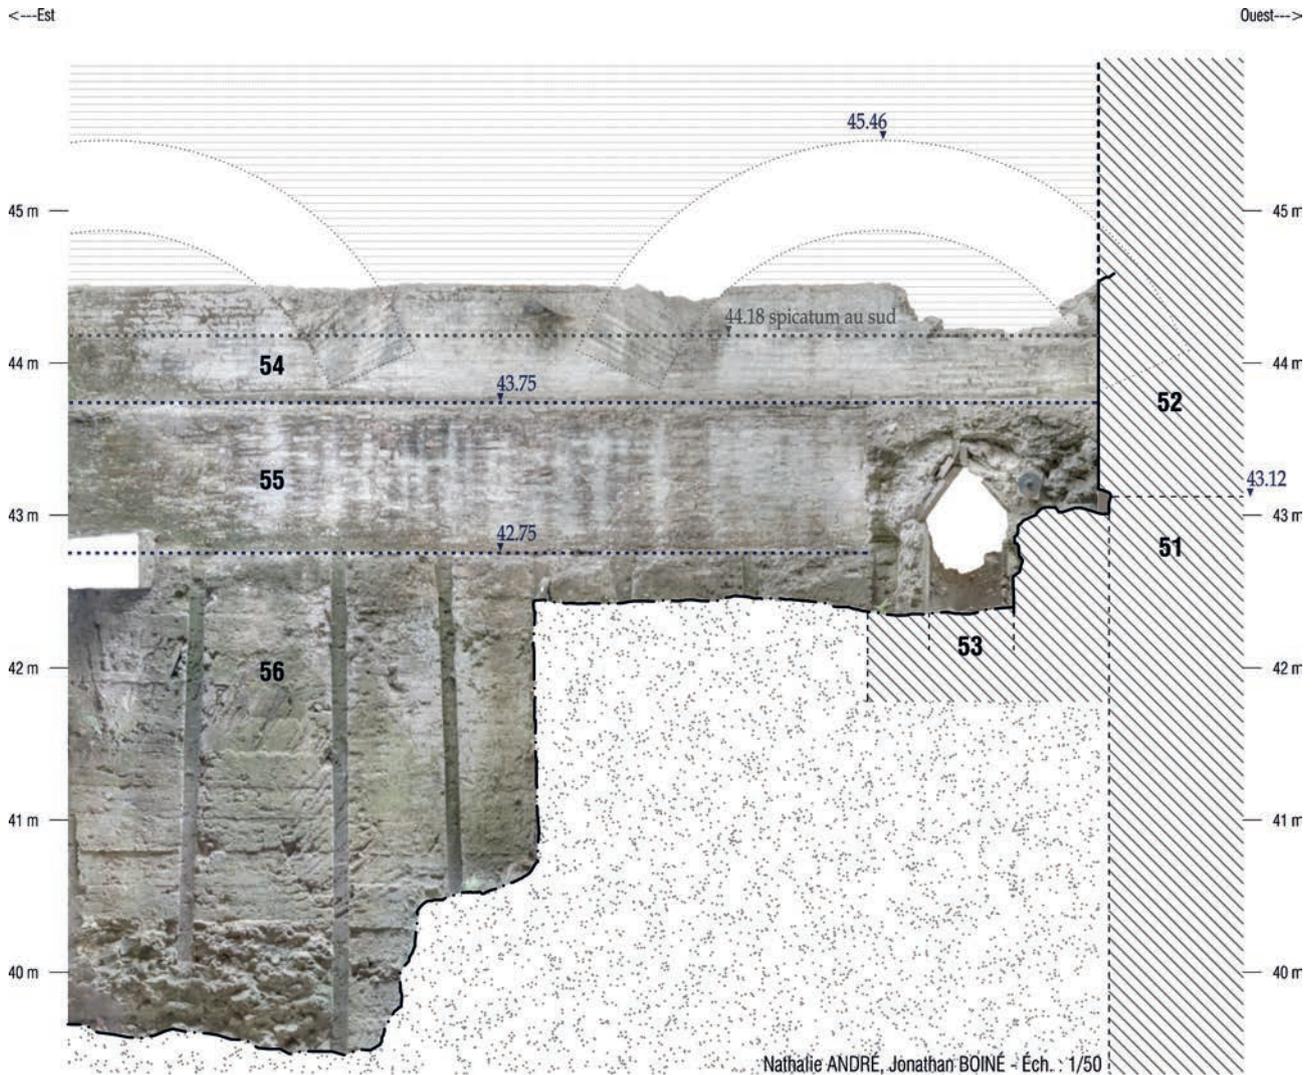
Face nord du mur 54 et de ses deux niveaux de fondation n^{os} 55 et 56.
